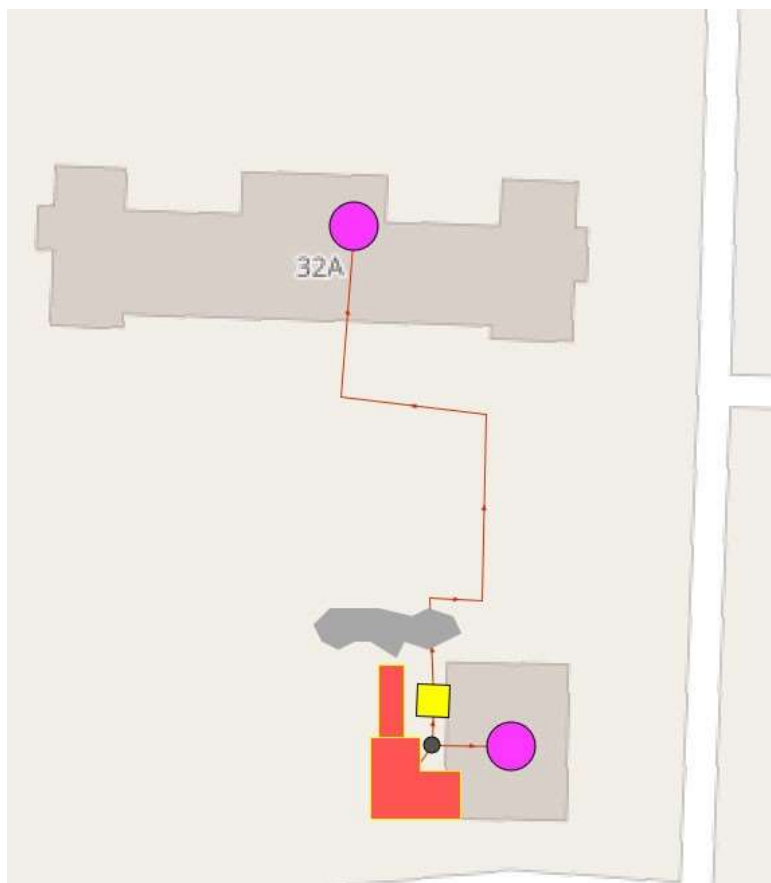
Схема тепловой сети котельной № 5
